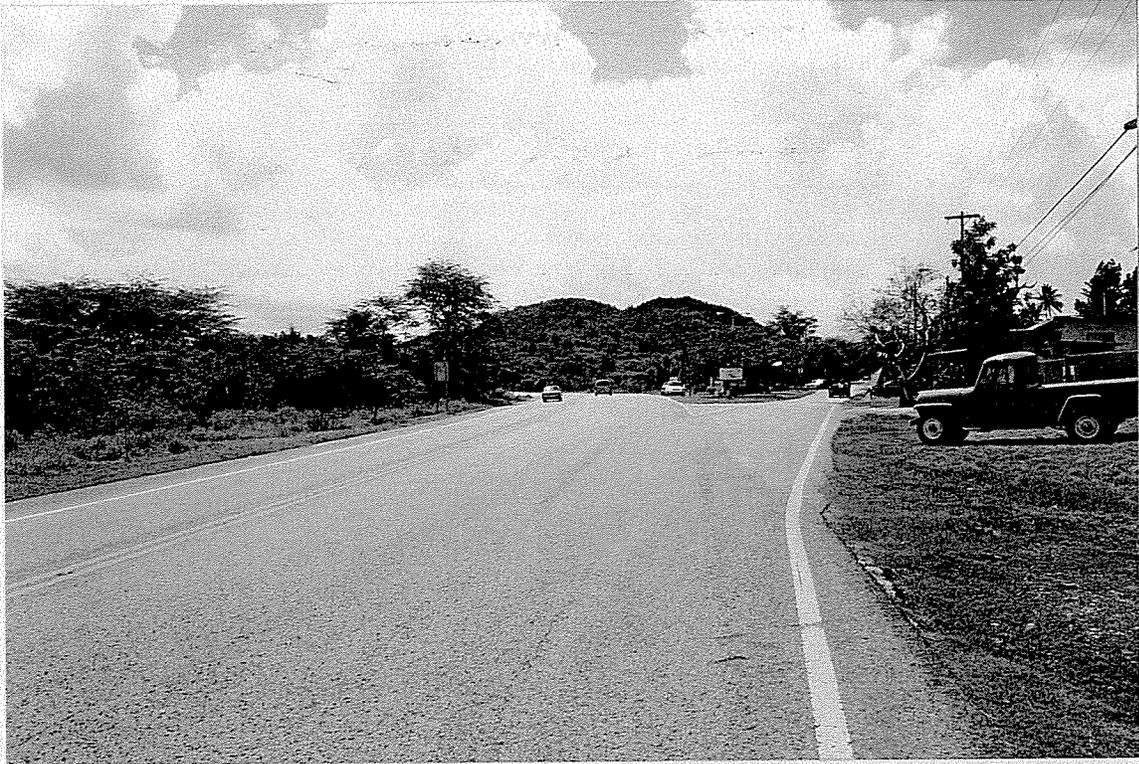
INTERSECCIÓN CARRETERAS PR-116 Y PR-3116 SUR, ACCESO NORTE
